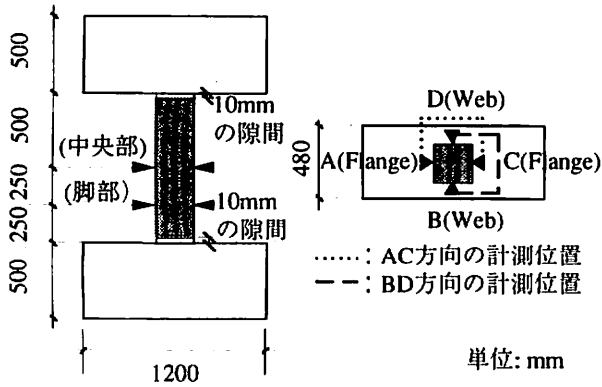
コンクリート打設時のCFRP管のはらみ出し量計測位置
